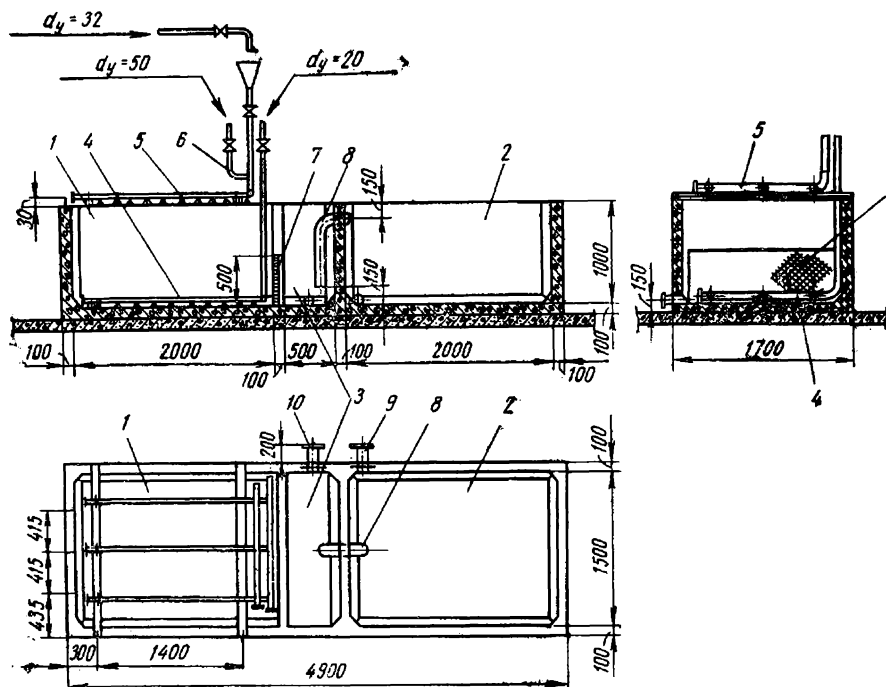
Железобетонный чан конструкции Гипромясо для приготовления тузлука.
